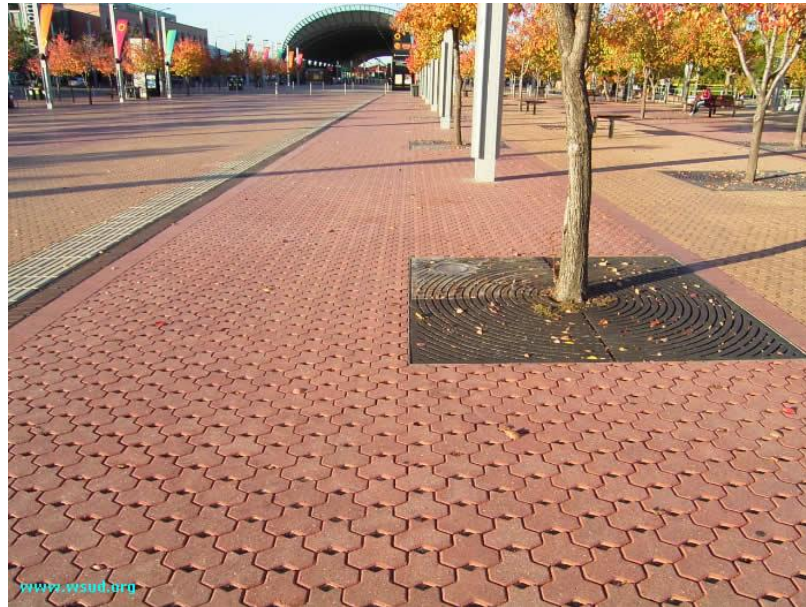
10: PAVIMENTO PERMEÁVEL – WSUD
